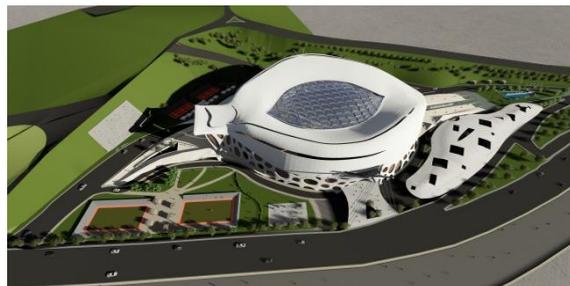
photo montrant l'implantation de projet tout au long de site. Source : auteurs
